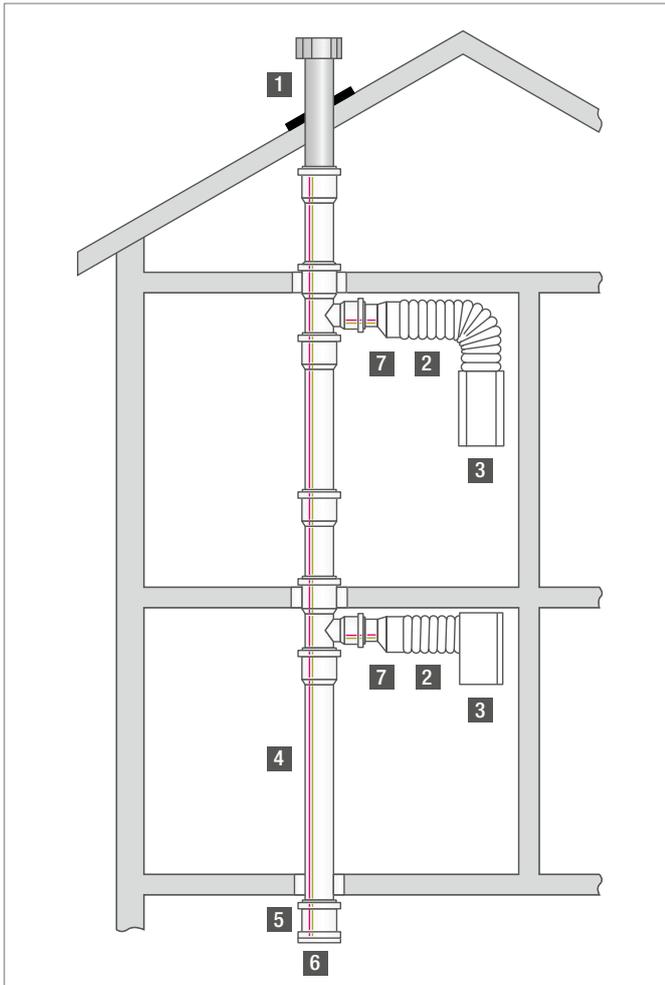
Extracción distribuida con RAUPIANO PLUS
